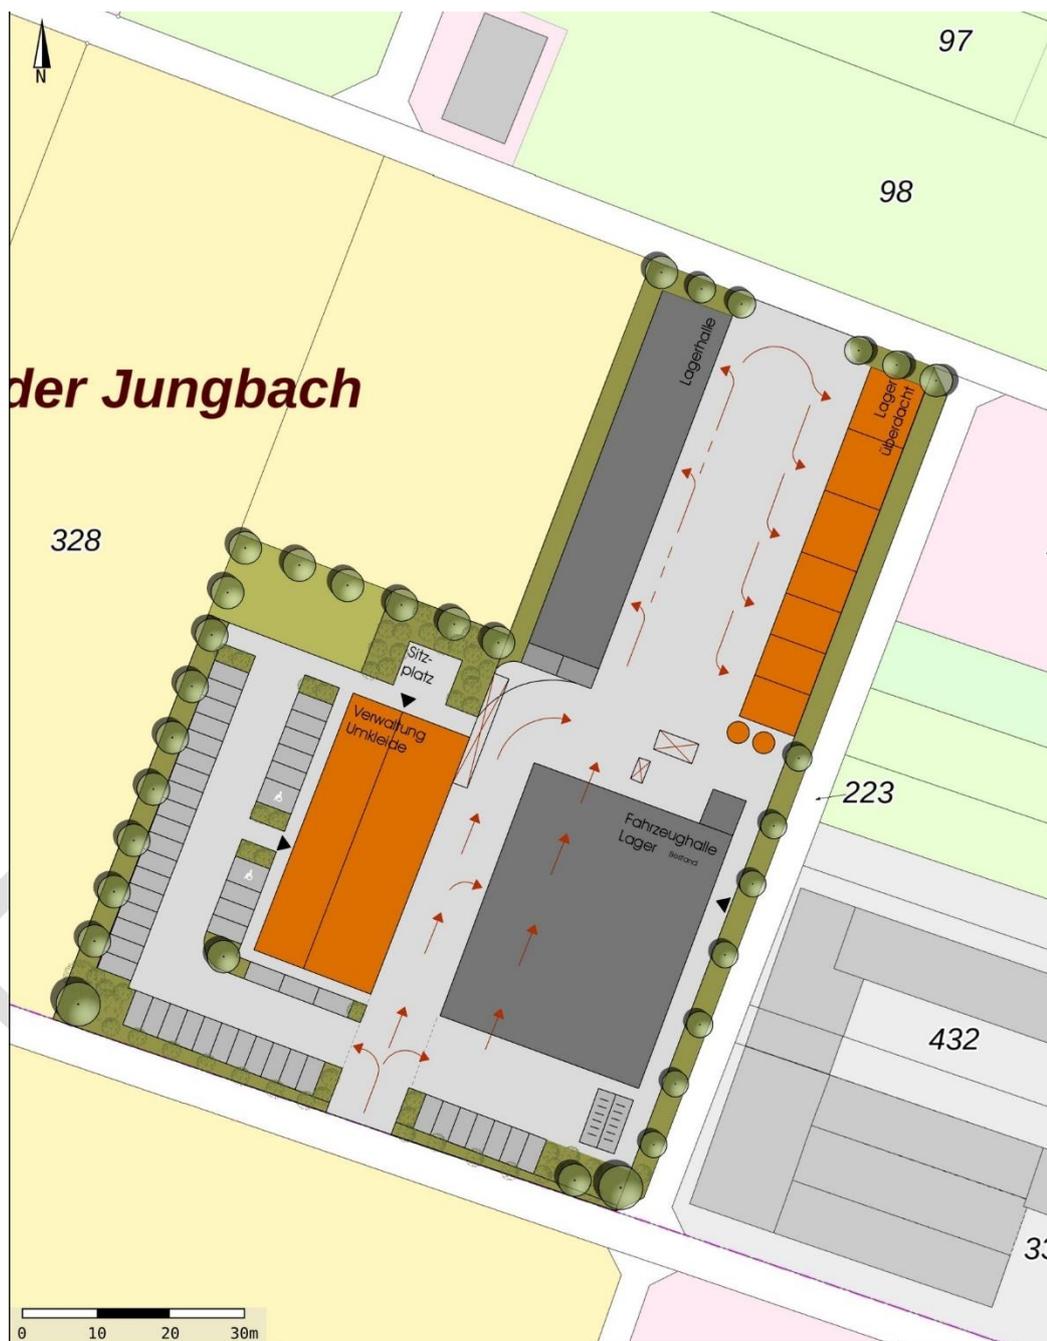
Lageplan des Funktions- und Betriebskonzeptes
